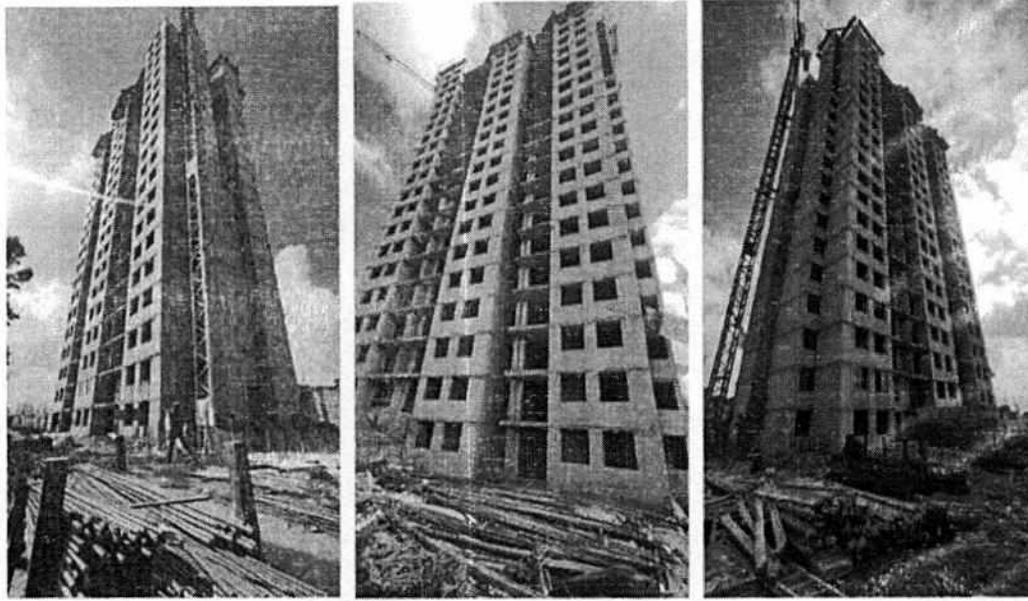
Estructura Torre A. Finalización de Estructura hasta cubierta.
